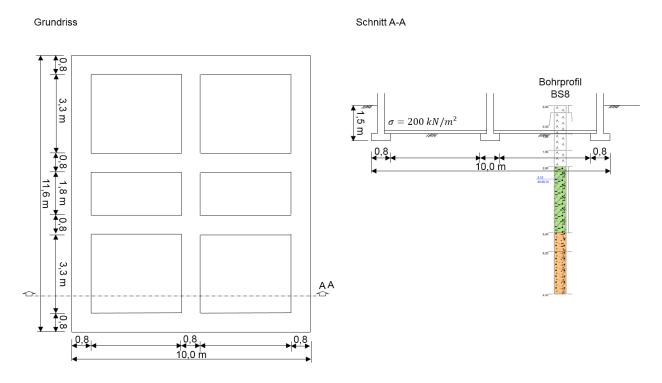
Repräsentatives Modellhaus für die Setzungsberechnungen, Grundriss und Schnitt mit maßgebenden Bodenprofil BS8
